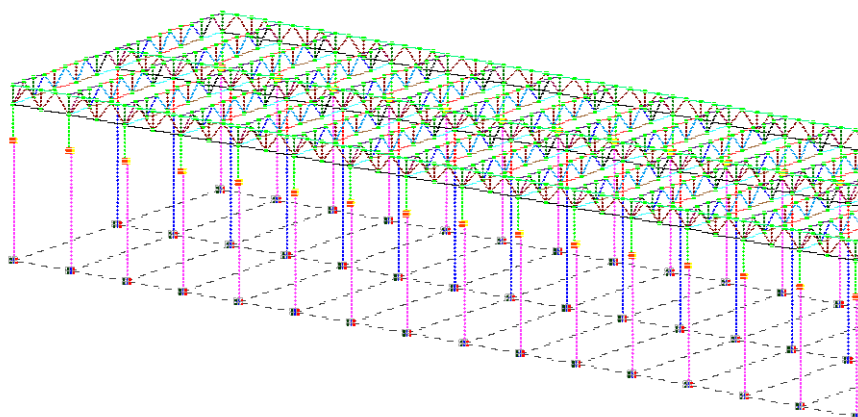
Фрагмент расчетной модели здания в программе Лира-САПР (подкрановые балки и вертикальные связи по колоннам условно не показаны)
